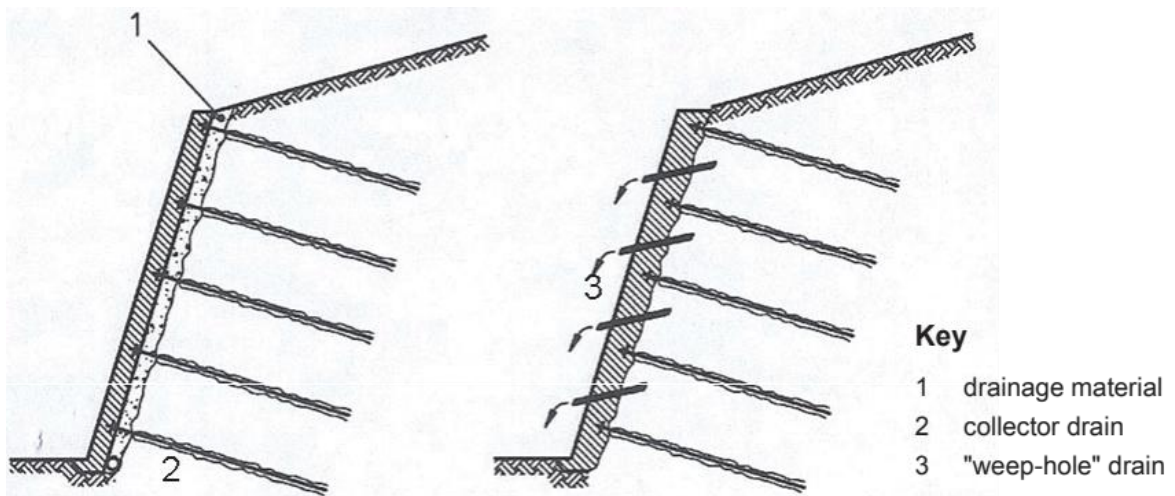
Sistemas de drenaje para drenar las aguas de trasdós del muro (Fuente: Execution of special geotechnical Works – Soil Nailing (BS, 2010))
